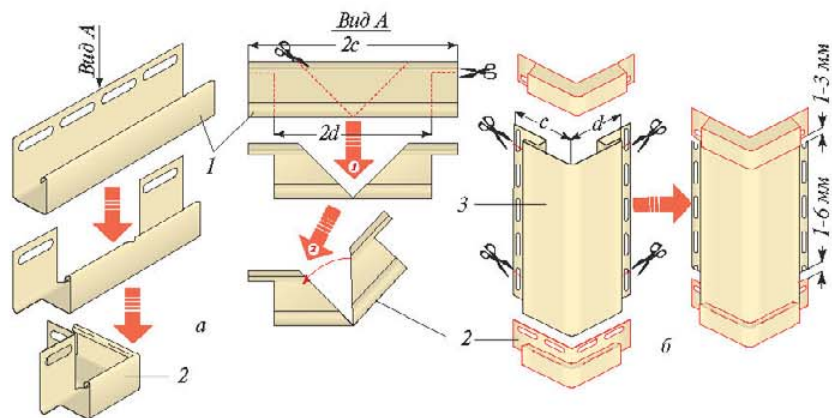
Изготовление и монтаж угловых крышек: а — изготовление крышки из J-профиля; б — монтаж крышек; 1 — J-профиль; 2 — крышка; 3 — угловой профиль
